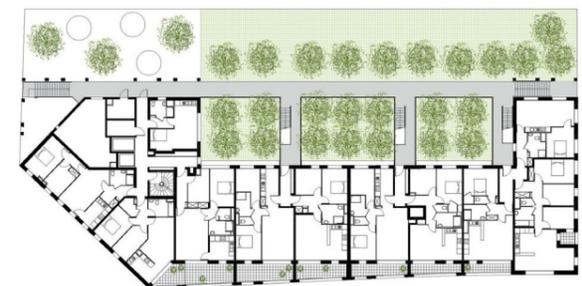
Planta tipo, Vivienda, Vry sur Seine. Fuente: Atelier du Pont
